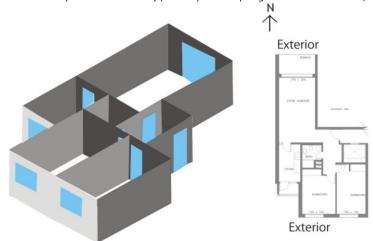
Modelo doblemente orientado y planta tipo de la tipología real . Fuente: Picción, et al 2008
